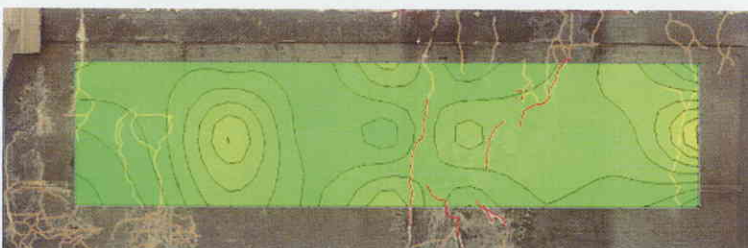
重ね合せ図 (原画像+ひび割れ+打音)
